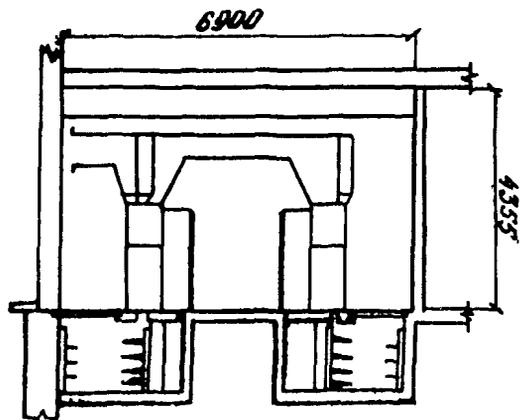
План размещения оборудования и механизмов при монтаже шкафов КРУ:
